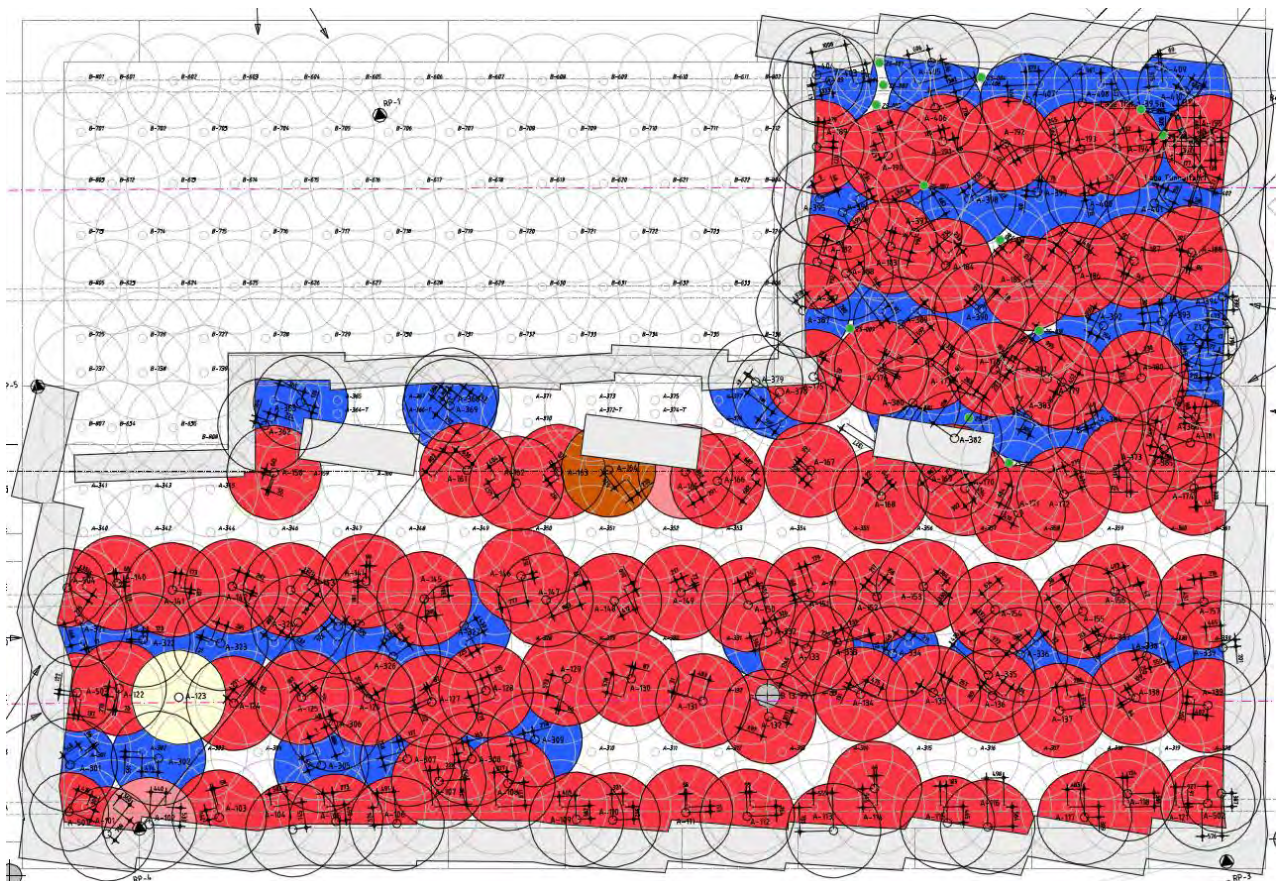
As built Plan Westschacht, Grundriss Dichtsohle, mit IST-Lagen der Primär- und Sekundärreihen sowie der SW-Lamellen [3]
